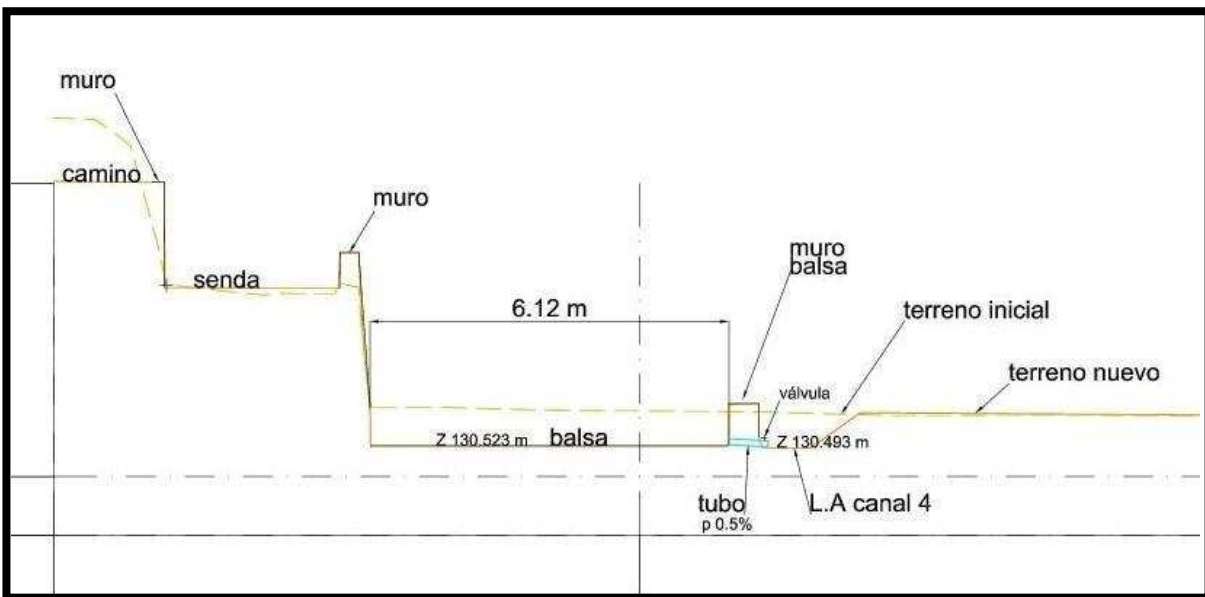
Perfil detalle conexión canal 4.
